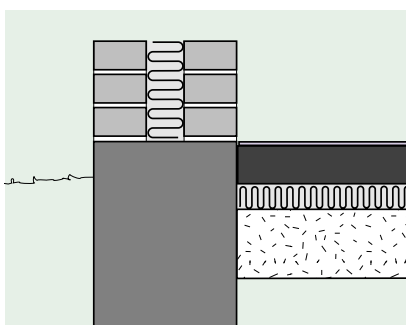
Terrændæk med gulvbelægning på beton, isoleringsplader og singel eller letklinker. Svømmende gulve.
